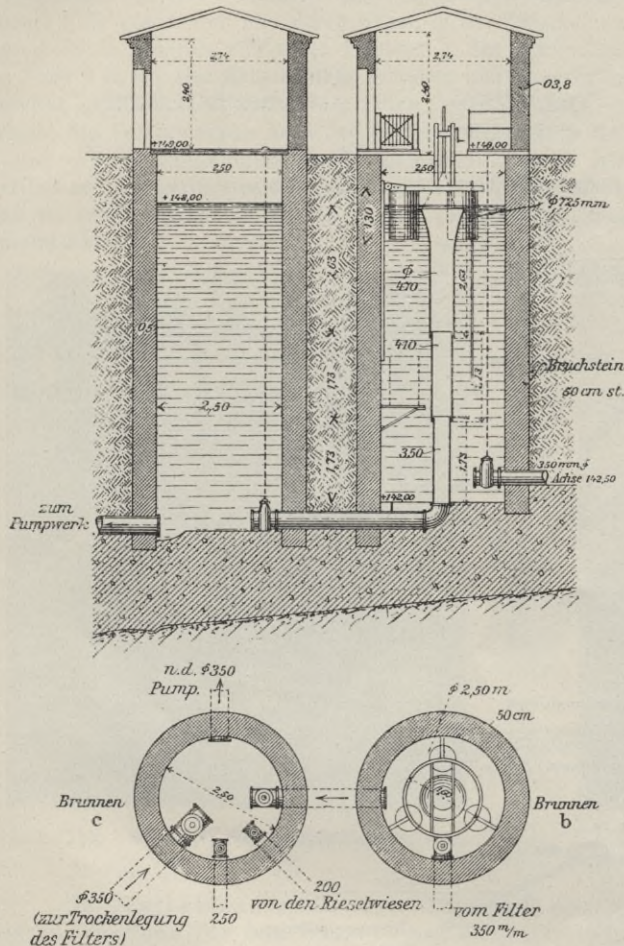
Entnahmebrunnen des Solinger Staudammes. 1:150.
